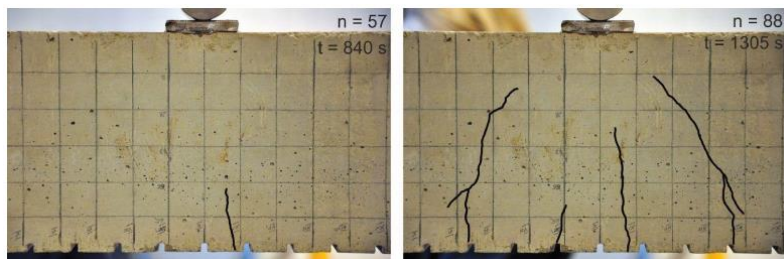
Evolução das fissuras em viga 2.
